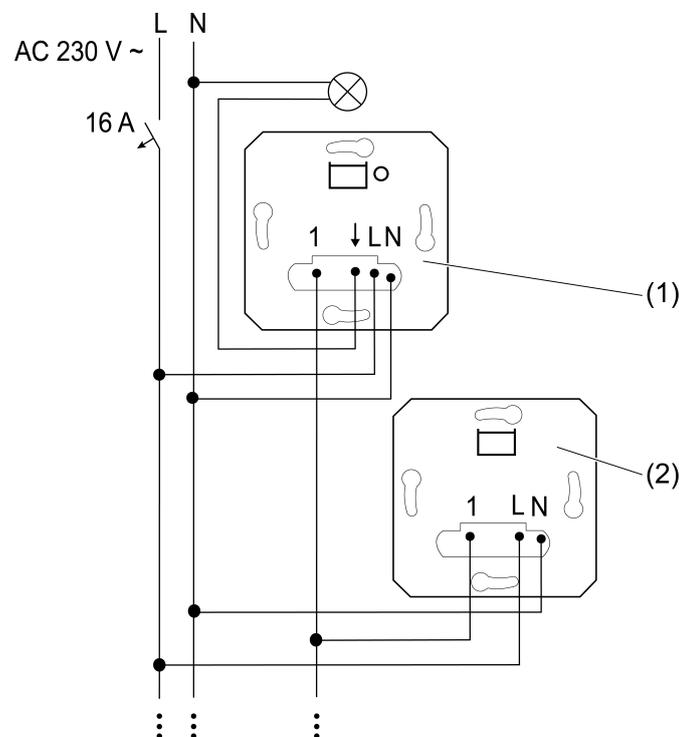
Anschlussplan 3-Draht-Nebenstellen an einer Hauptstelle
